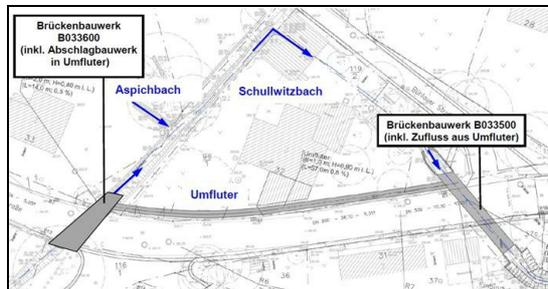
Planung - schematischer Lageplan Brücken und Umfluter, 25.11.2014
